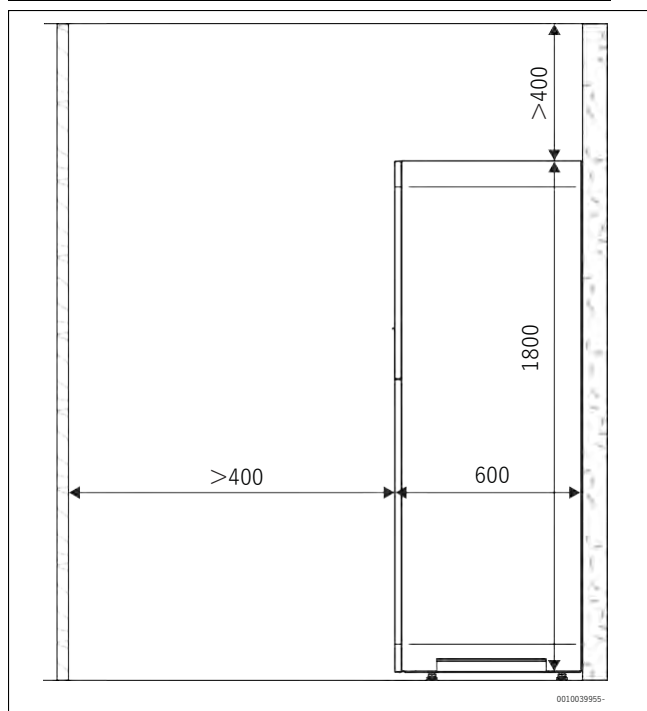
Minimální odstupy CS3400i AWS 10-14 OR-T (rozměry v mm)
